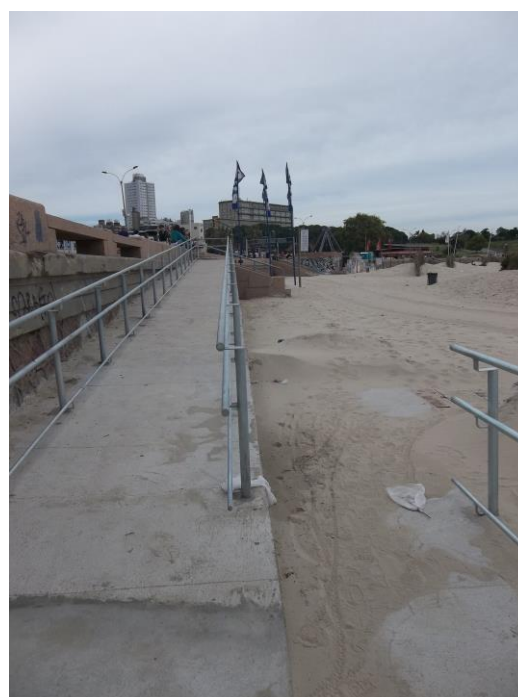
Vista transversal de ambas ramas de la rampa de acceso en Playa Ramírez.
